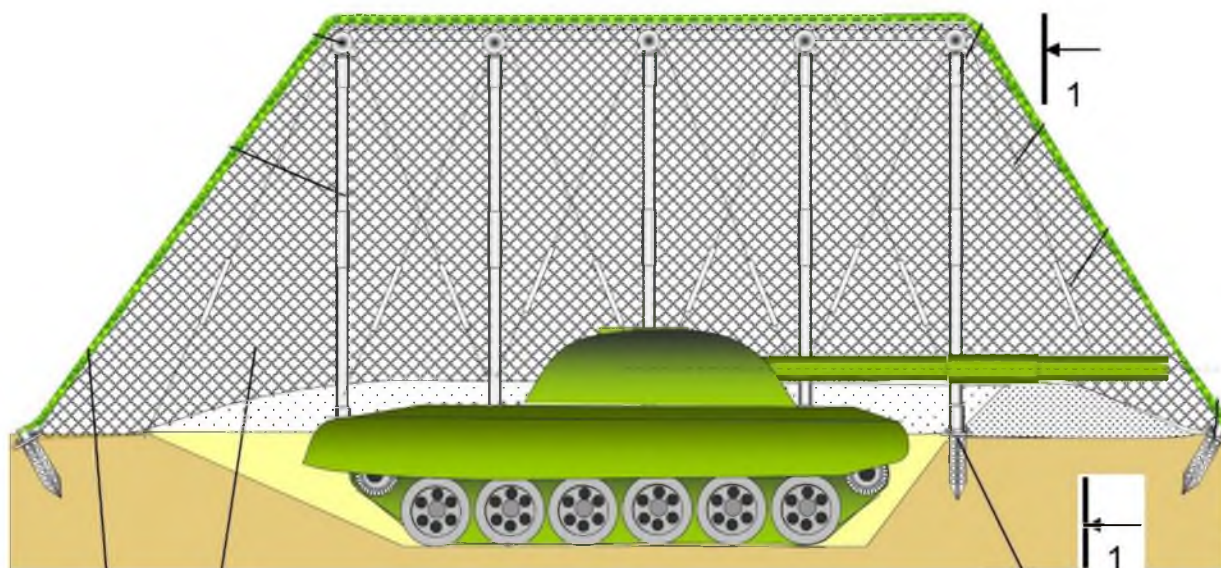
Расположение боевой техники под защитой ЗМЭ. Вид сбоку
